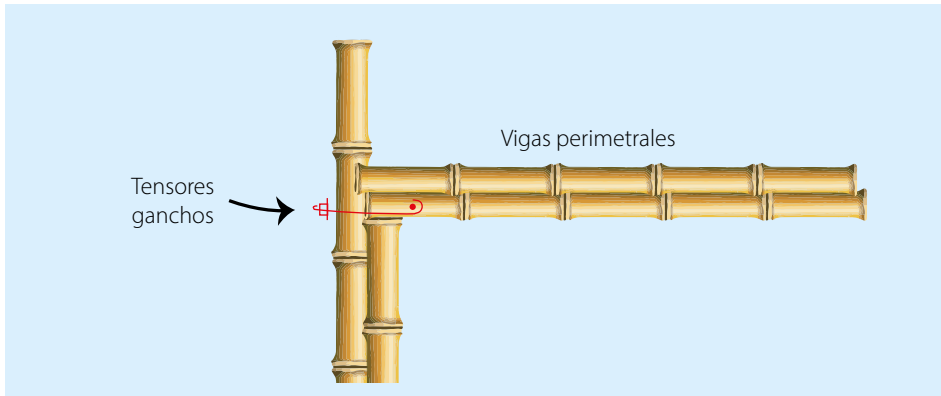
Ganchos o tensores para fijar vigas perimetrales.
